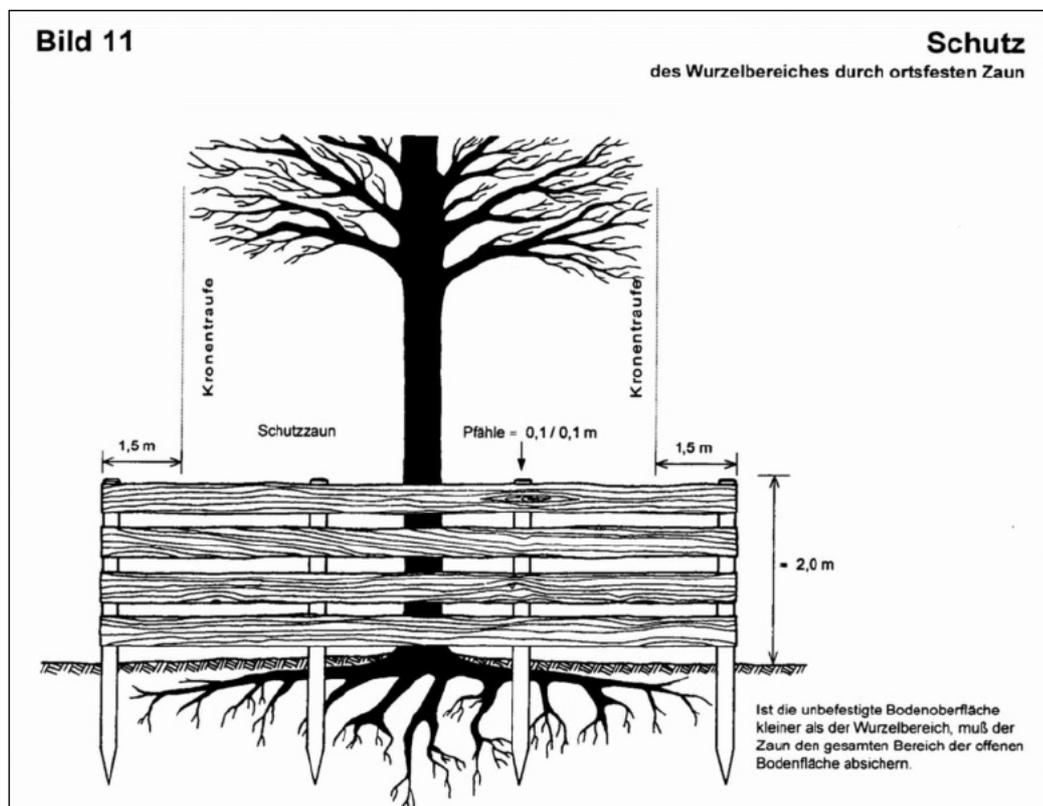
Fachgerechter Aufbau eines Baumschutzzaunes nach DIN 18920
